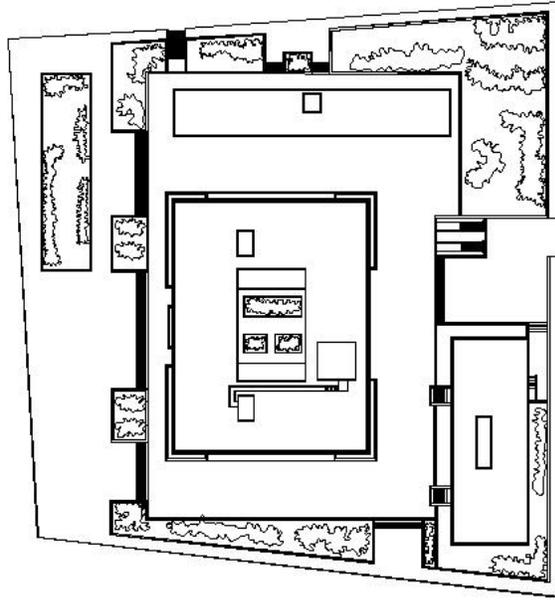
Planta de Conjunto de la Delegación Gustavo A. Madero. Fuente: FRMH y AOV.
